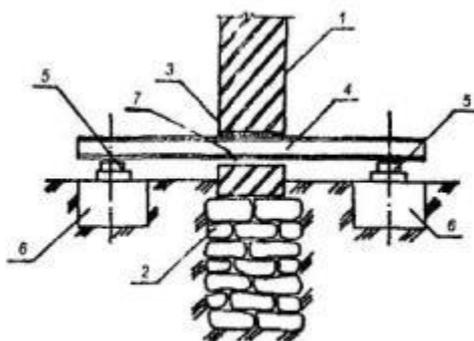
1 - кирпичная стена; 2 - фундамент, подлежащий замене; 3 - подкладки; 4 - металлические поперечные балки; 5 - гидравлические домкраты или подкладки; 6 - временные опоры; 7 - отверстие в стене.
